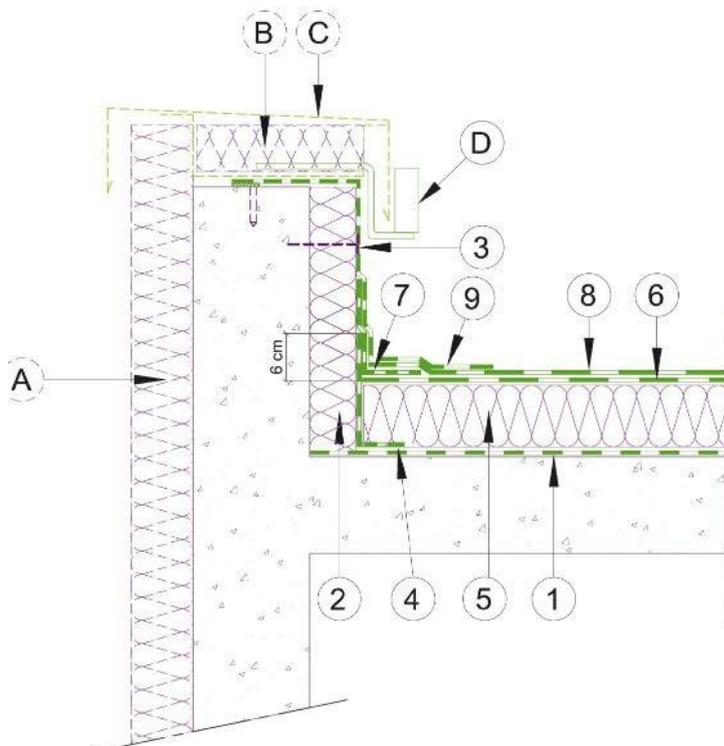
Revêtements d'étanchéité bitumineuse sur acrotère _ Source : Cahier CSTB 3741
